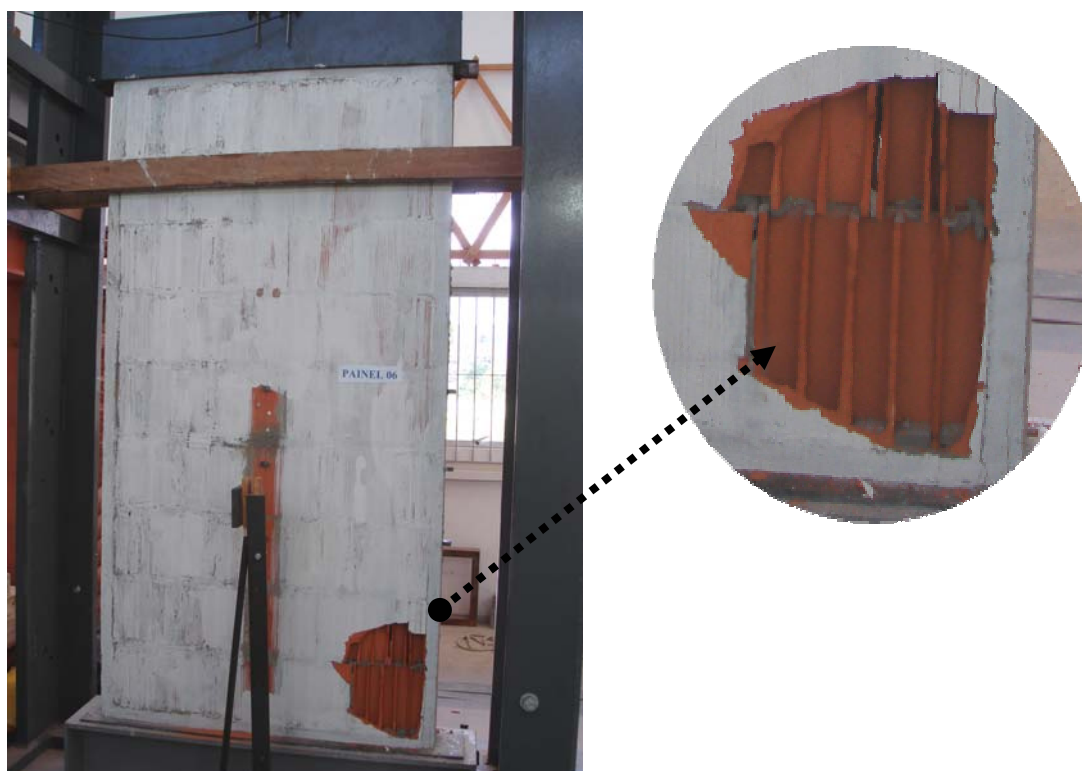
Forma de ruptura ocorrida pelo painel com junta de argamassa armada
